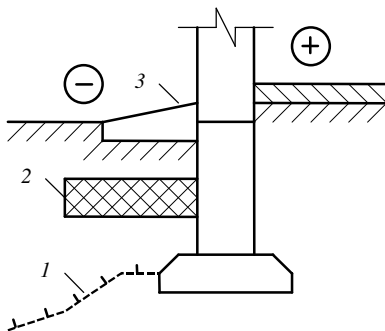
Теплова ізоляція ґрунту біля фундаменту:
